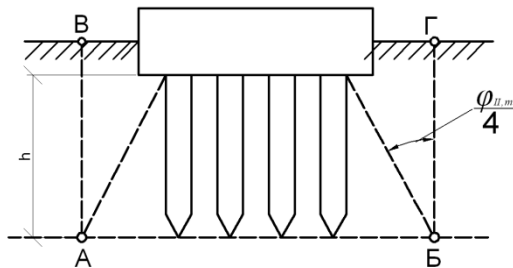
Определение границ условного фундамента при расчете осадок свайных фундаментов при вертикальном расположении свай
